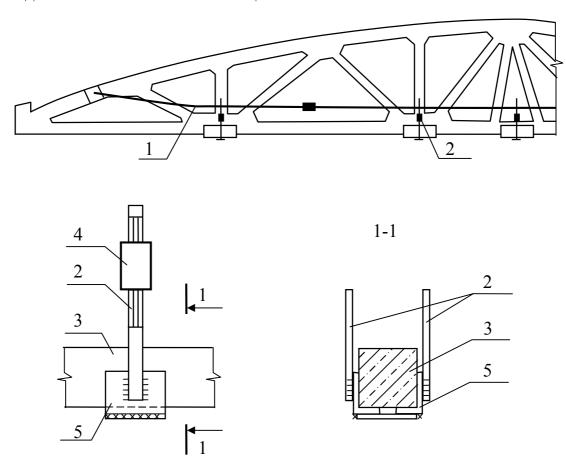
Усиление железобетонных ферм шарнирно-стержневыми цепями в пределах высоты фермы:
